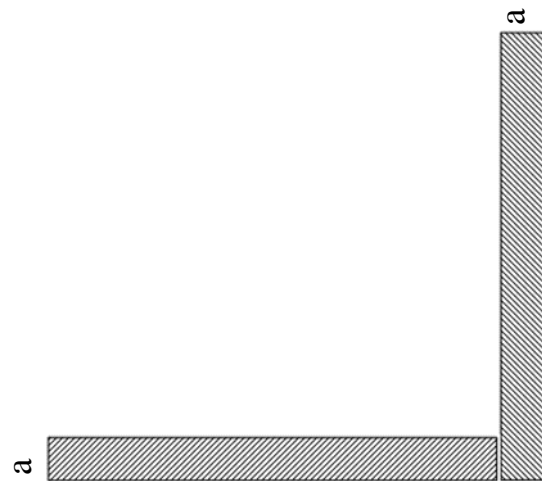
Vue en plan du voile de 3^{ème} type.
